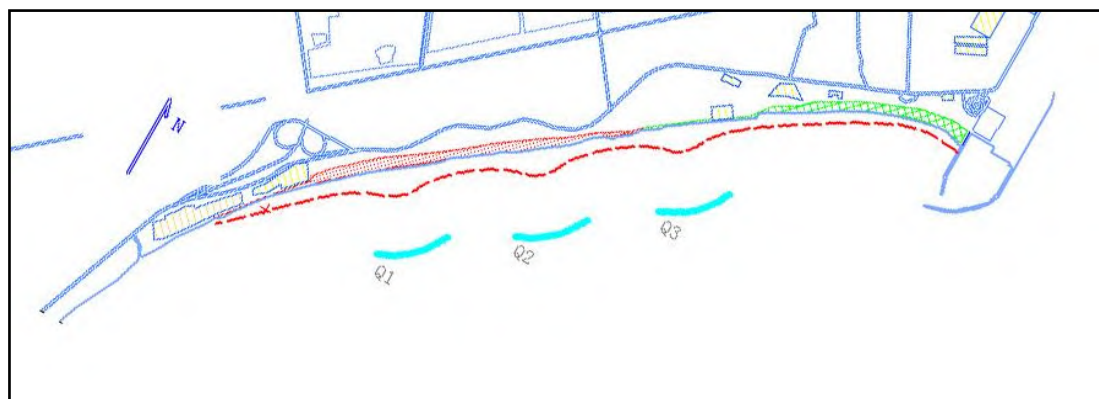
金梦海湾海滩整治修复工程平面布置图
